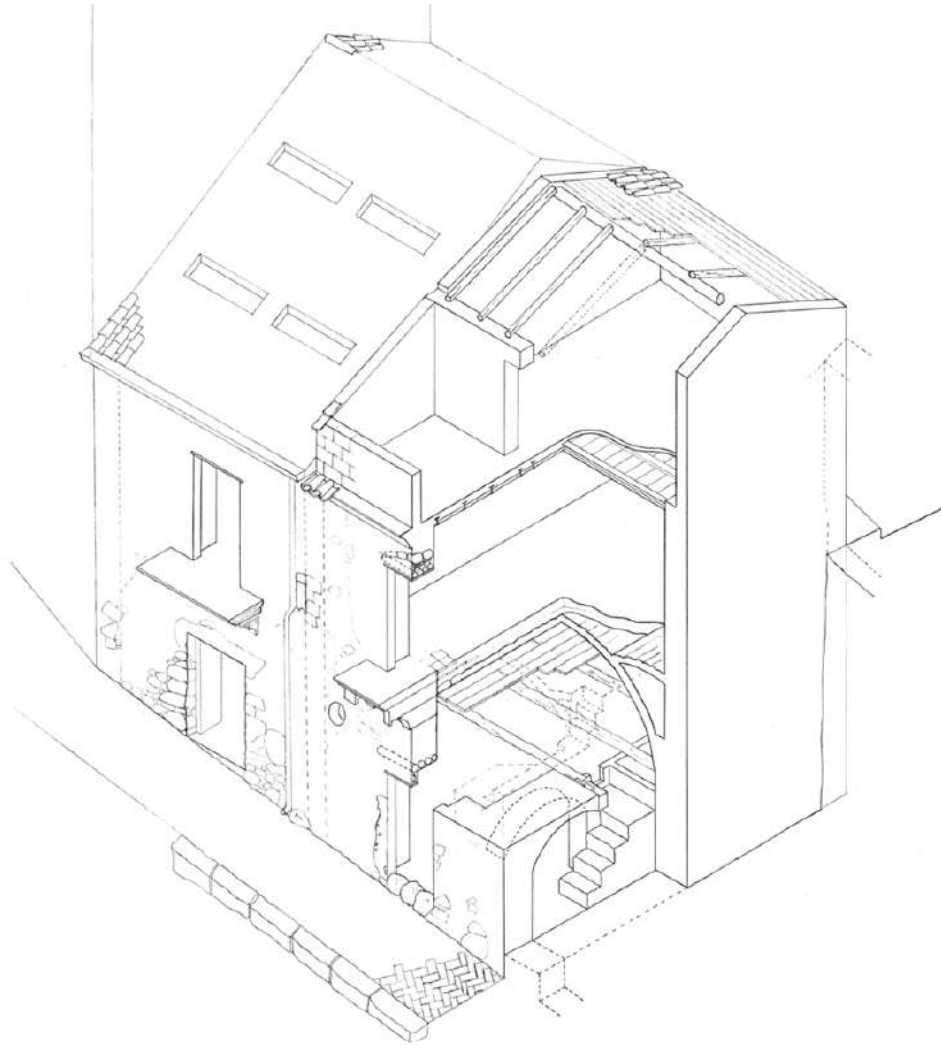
Esempi di sopraelevazione e differenziazione dell'accesso lungo la via Garibaldi.
